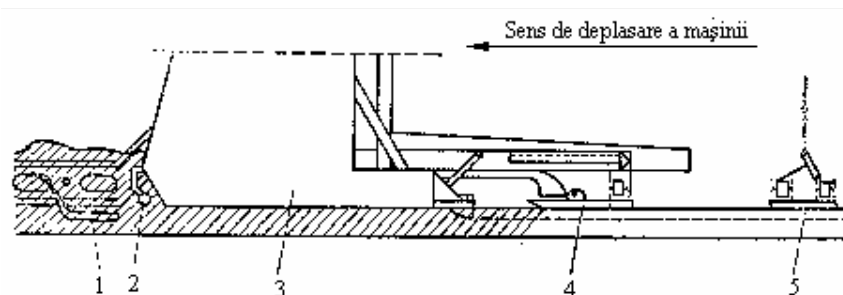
Schema de funcționare a unei mașini cu cofraje glisante tip "Günter und Zimmerman": 1 - pervibratoare; 2 - tub vibrant transversal; 3 - placă de împingere (mulare); 4 - placă de nivelare suspendată; 5 - placă de vibrație auxiliară.
